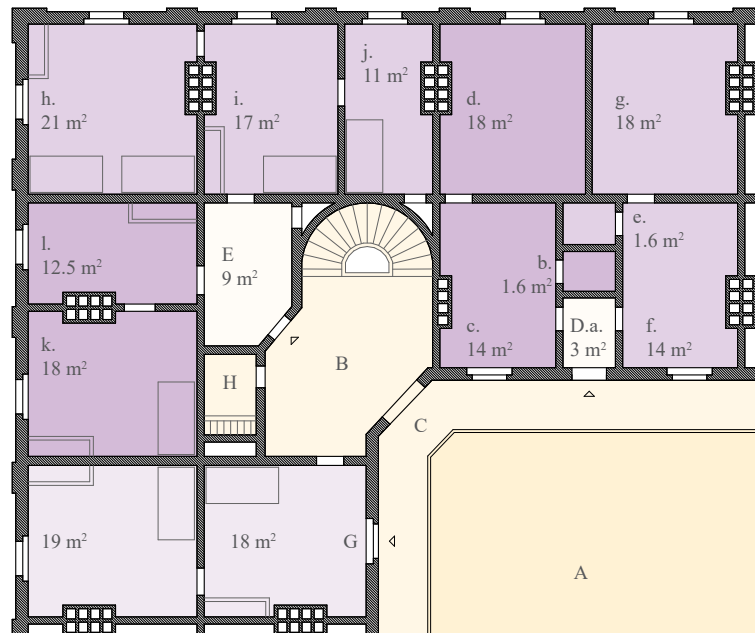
Plan d'étage type du pavillon central du Familistère de Guise.
